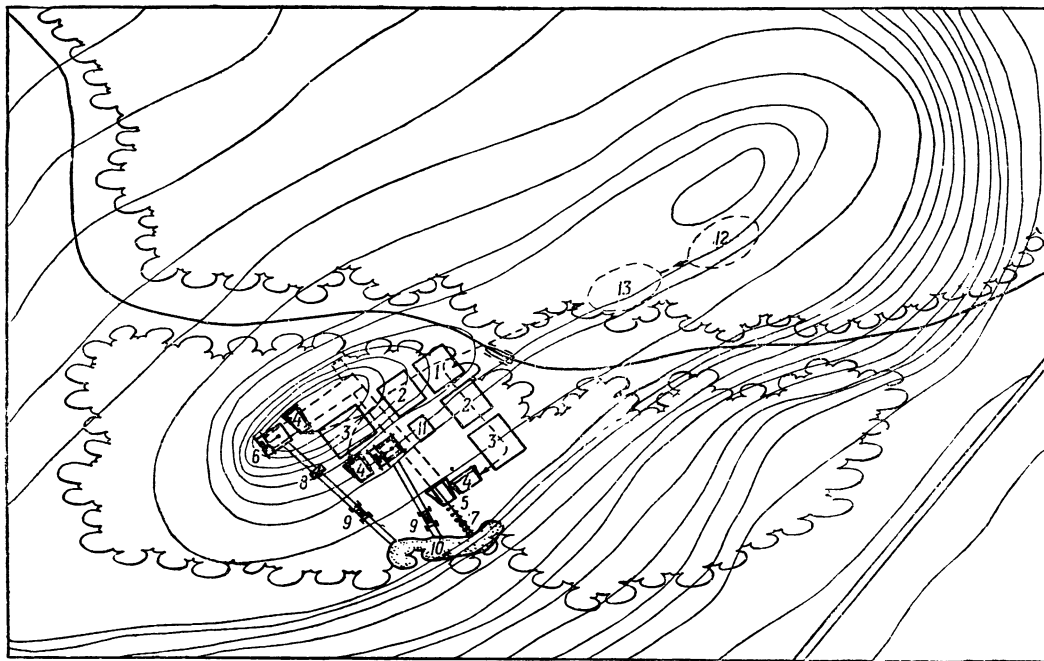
Схема строительной площадки при возведении убежища на 10—20 человек:
